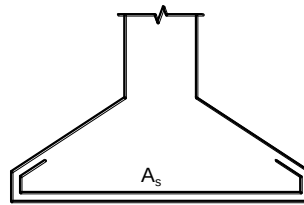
Sapata de fundação com a armadura principal A_s .
